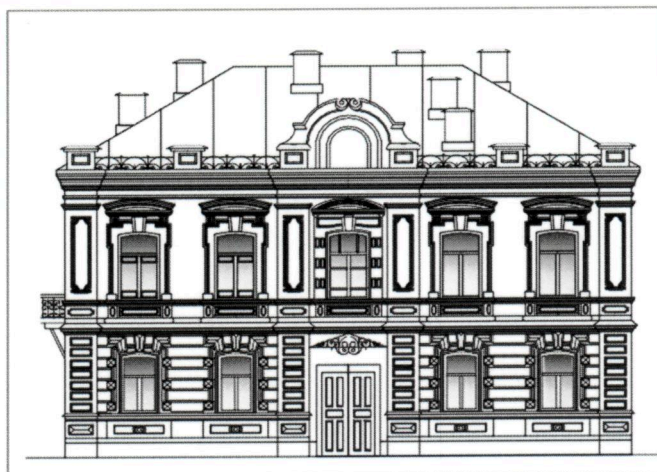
Главный фасад по улице Нагорная (южный фасад)
